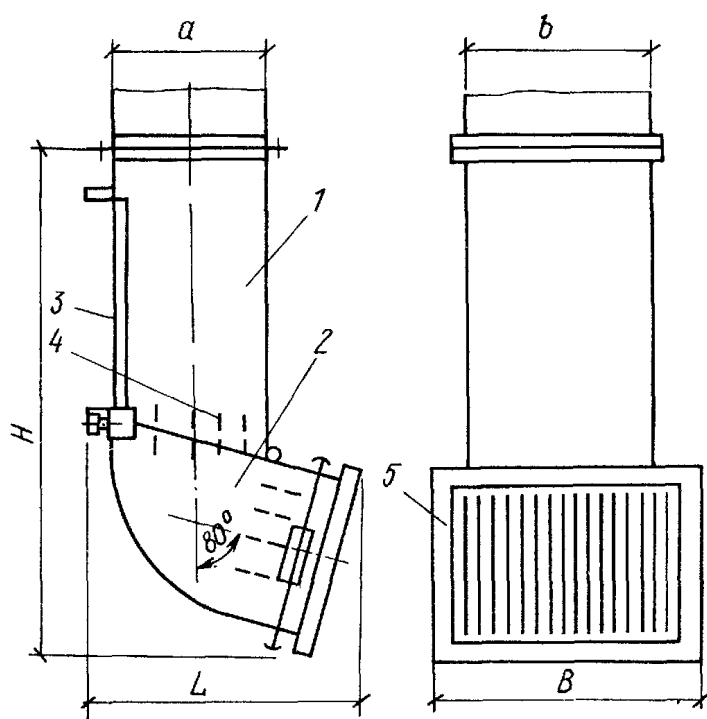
Воздухораспределитель поворотный регулируемый типа ВП с соединительным патрубком прямоугольного сечения - ВП1 и ВП2
